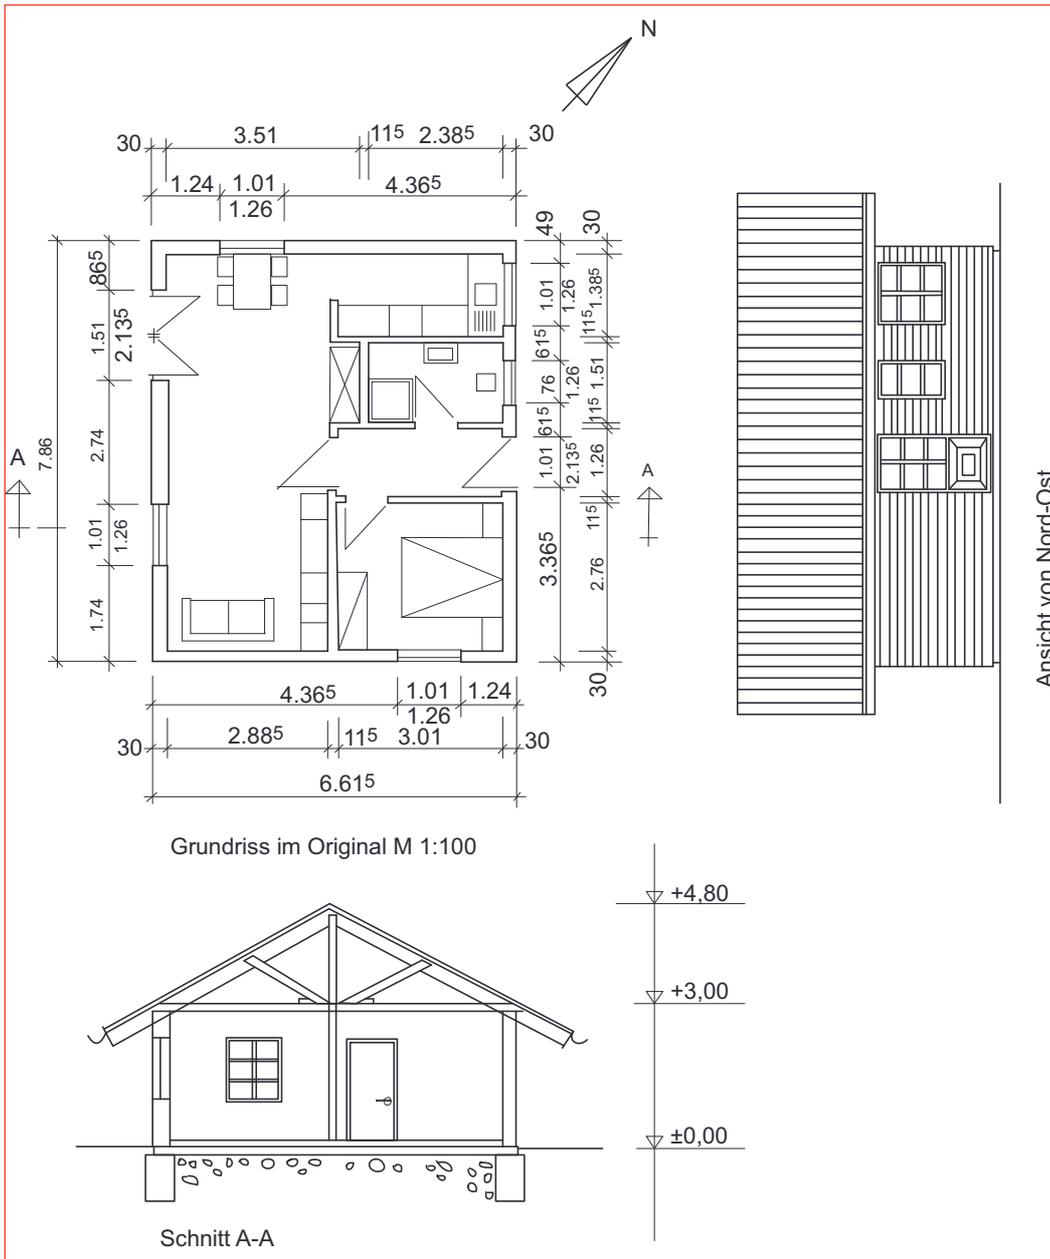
Ausführungsplan mit Baunennenmaßen (Auszug)
